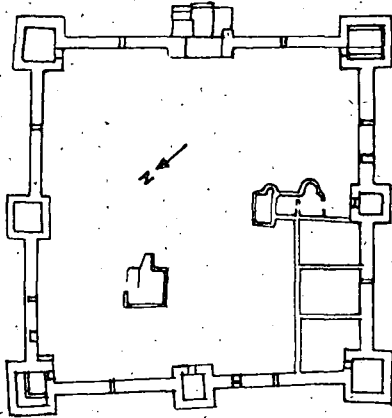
Grundriss des Kastells von Irgenhausen (nach Schulthess)
